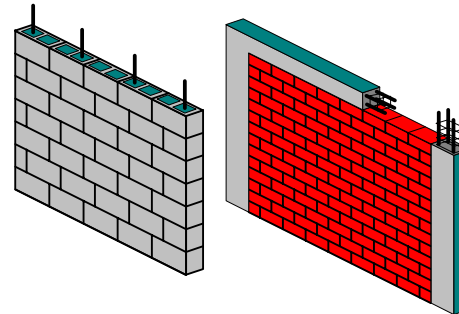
Sistemas estructurales de resistencia sísmica
